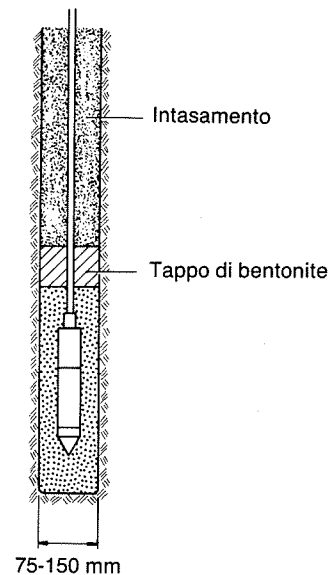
Installazione di piezometri tipo "Casagrande".
